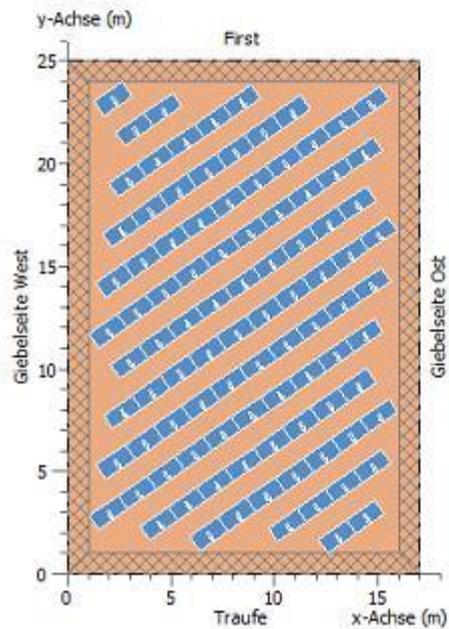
Dachplan zur Modulbelegung Grundschule Schönwalde-Siedlung
